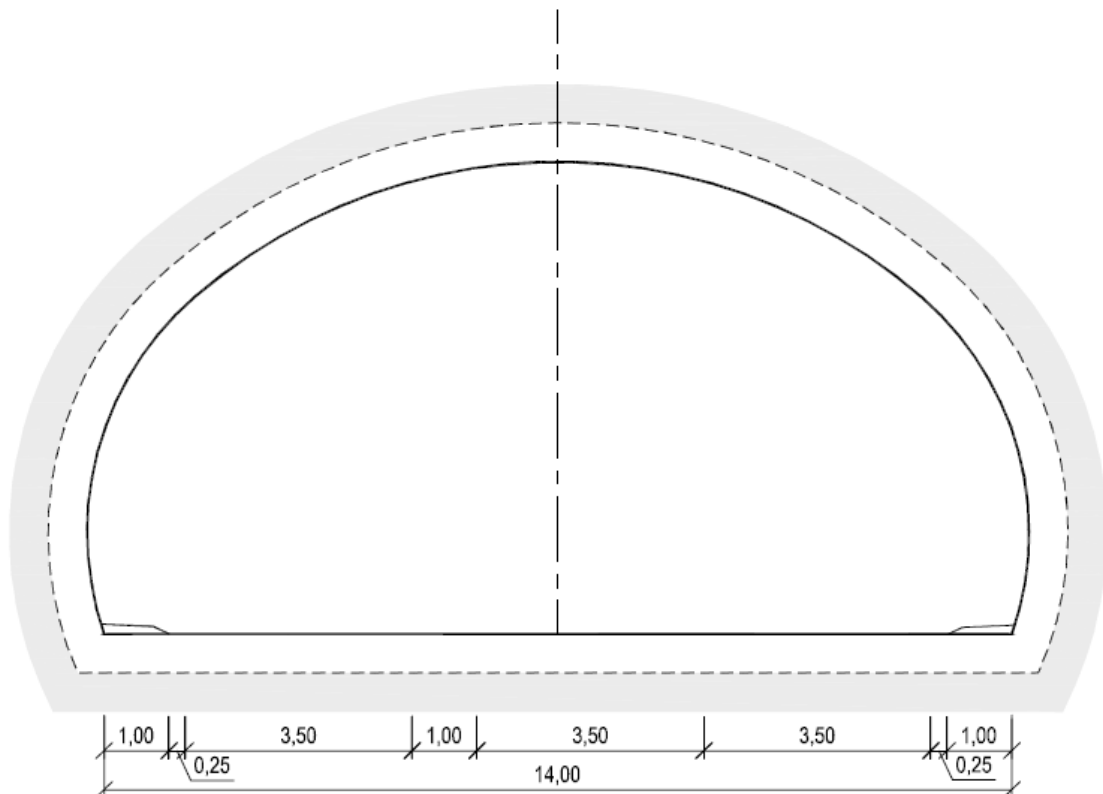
Tunnelprofil T13,5 (mål i m).
